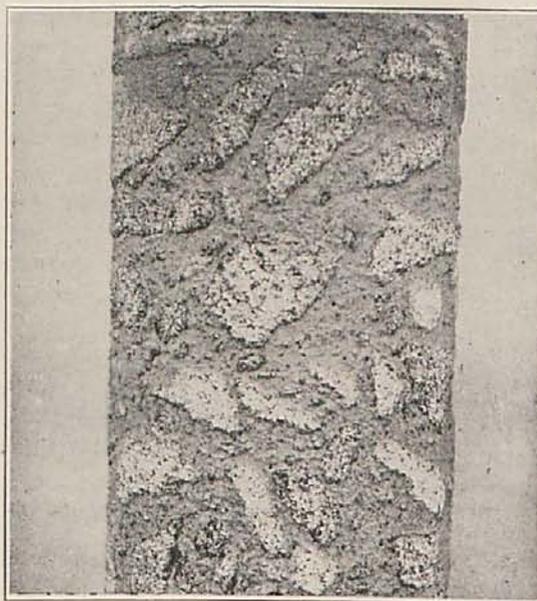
Detalle de un testigo del hormigón de la presa.
